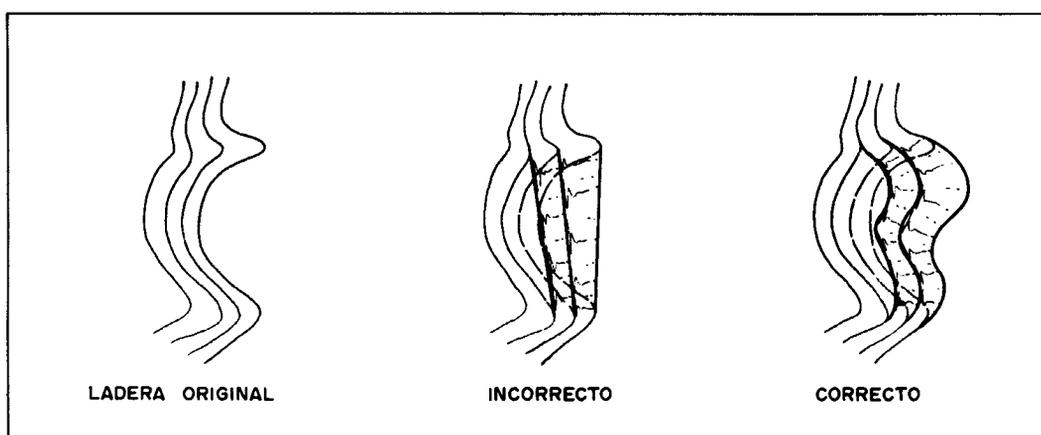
Adaptación de las proyecciones en planta de los vertederos a la fisiografía
